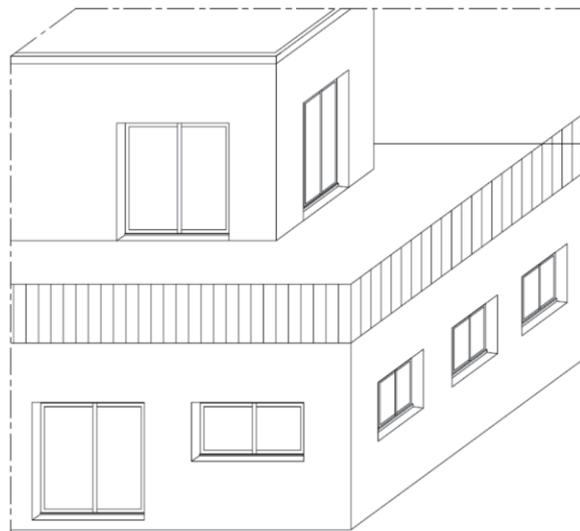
Exemple d'une toiture-terrasse accessible aux piétons et au séjour
